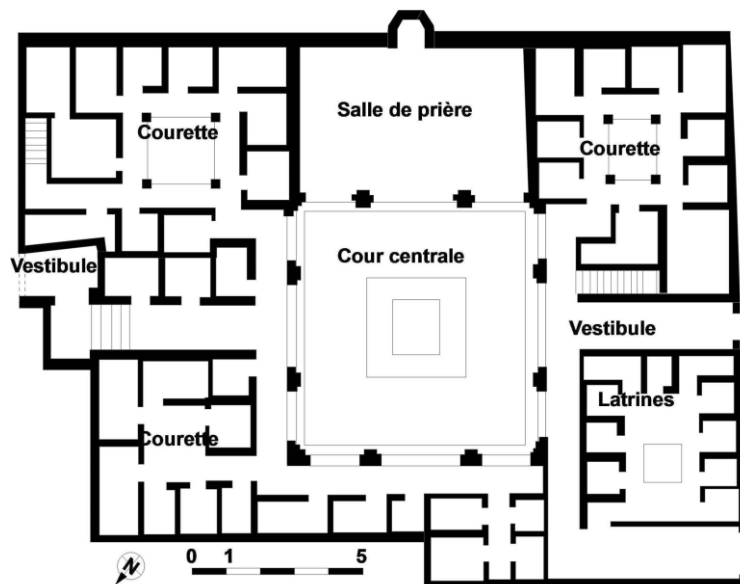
Vue en plan du rez-de-chaussée de la medersa ech-Charrâtîne
